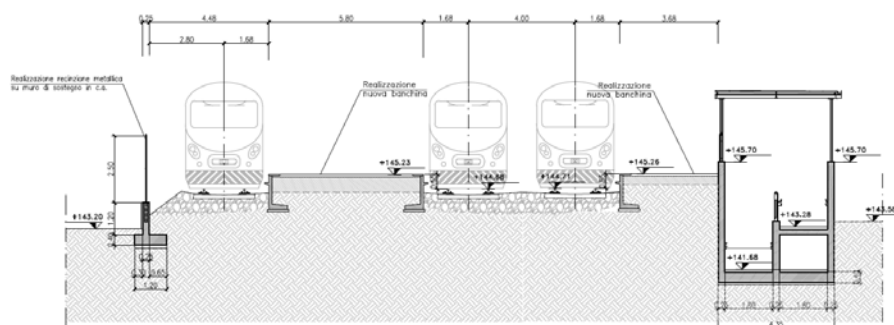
Sezione tipo banchine e corpi scala/rampe
